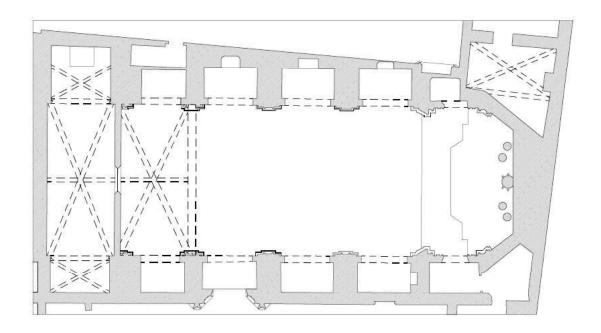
Planta baja Iglesia* ELABORACIÓN PROPIA
